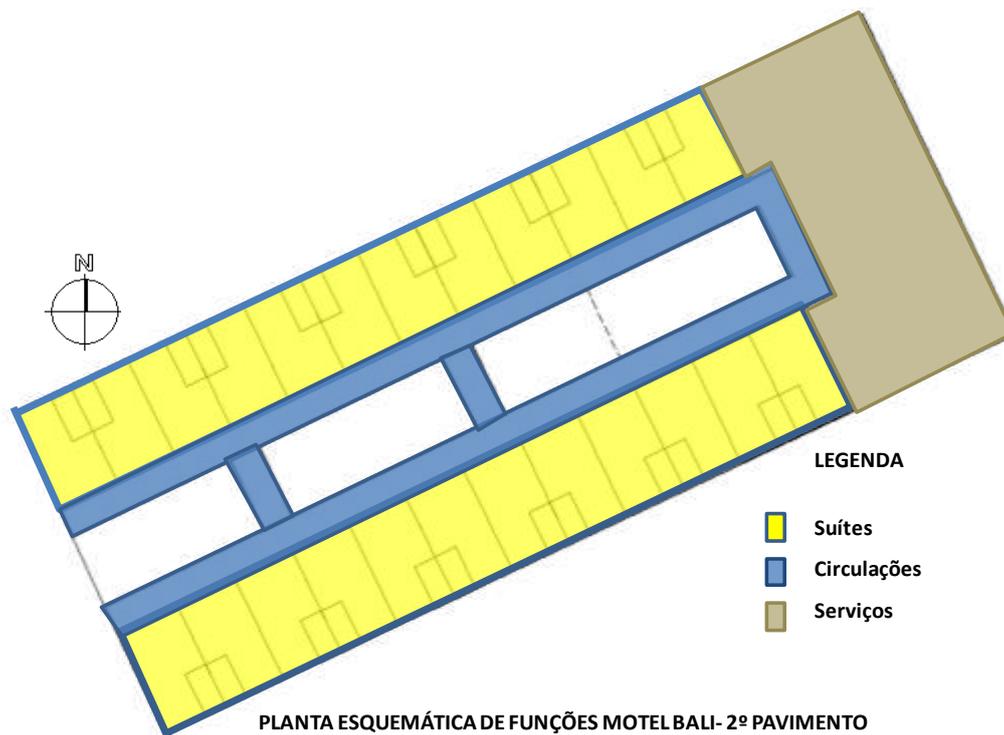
Planta esquemática de funções do 2º pavimento do Motel Bali (AUTORA, 2010)
